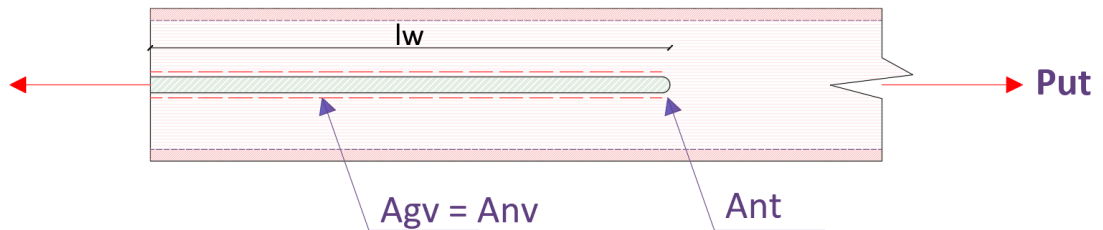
Longitud de soldadura arriostramiento superior.
